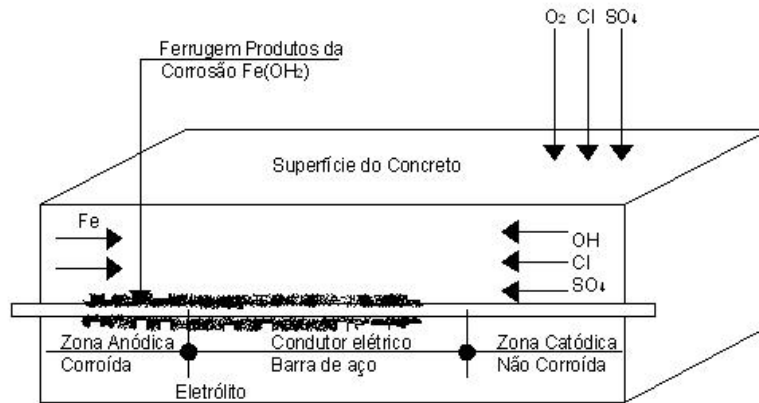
Formação de pilha de corrosão em concreto armado
